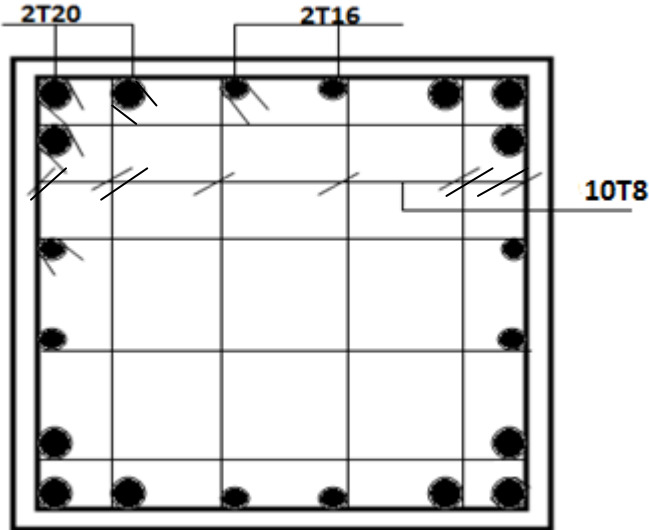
Schéma de ferrailage du poteau 60x60 (relié avec un voile)
